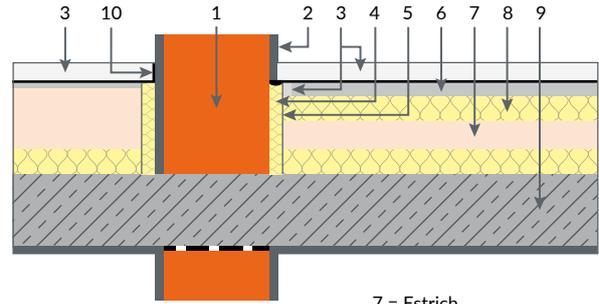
Schwimmender Estrich auf den Podesten bei elastischer Auflagerung der Treppenläufe (Grundriss)
